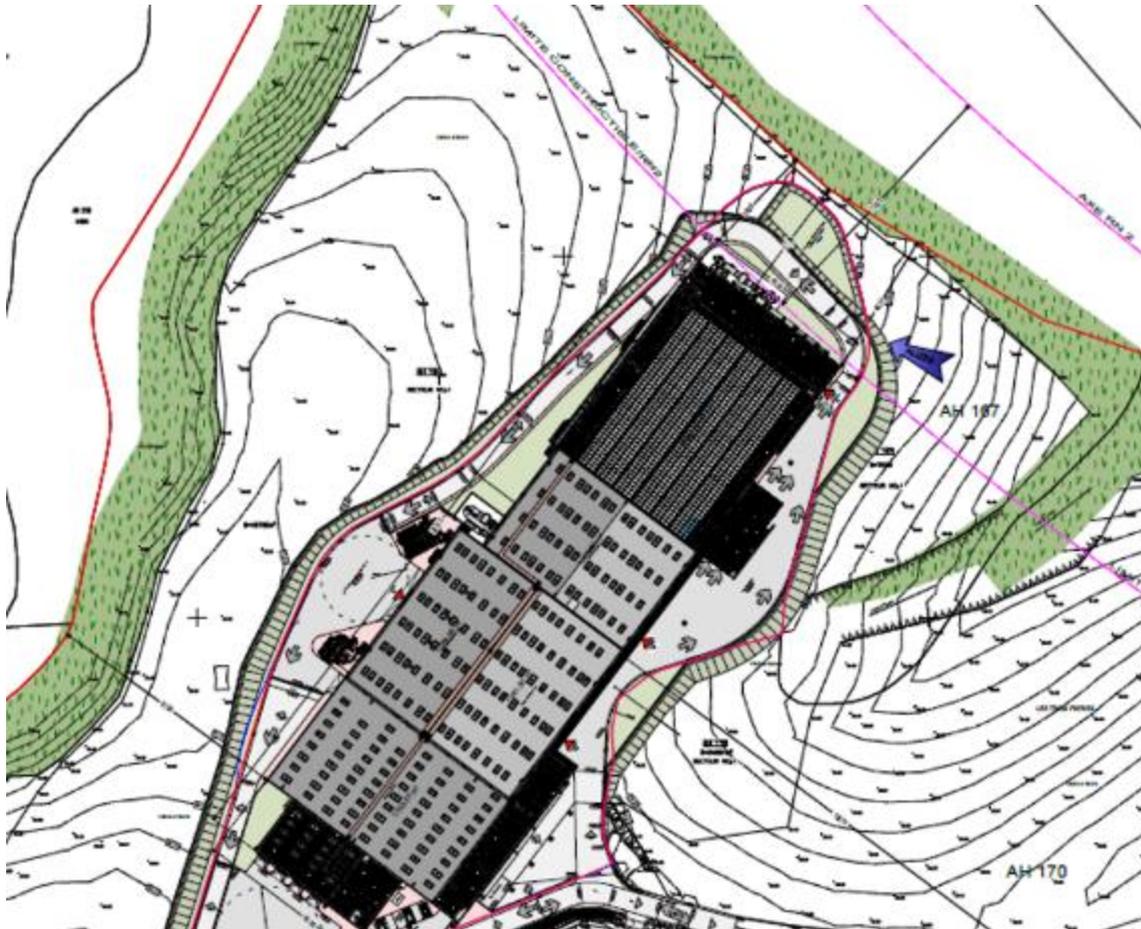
Position des constructions par rapport à la bande non constructible de la N2
